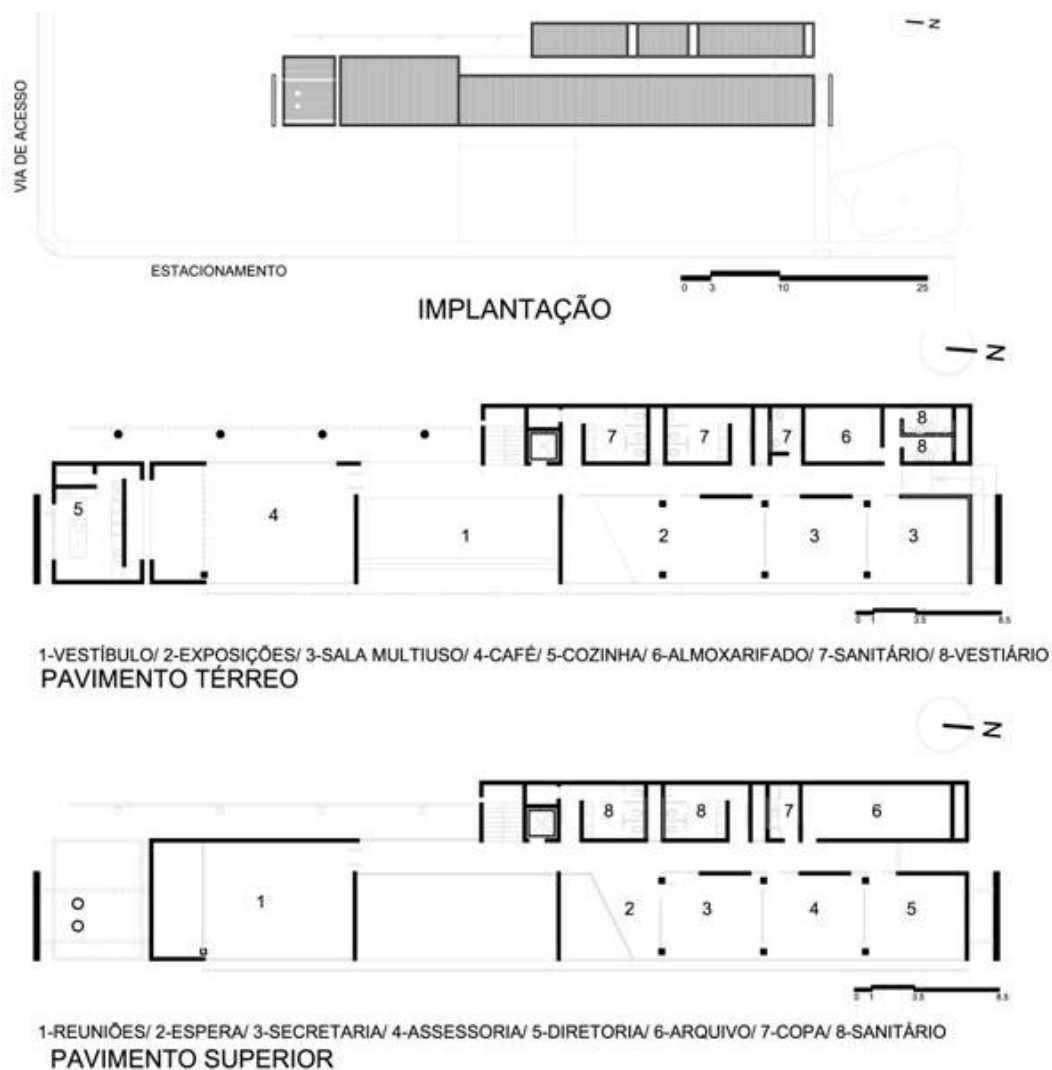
Planta de implantação, pavimento térreo e pavimento superior da Casa do Professor (MARCHIS et al, 2011).
